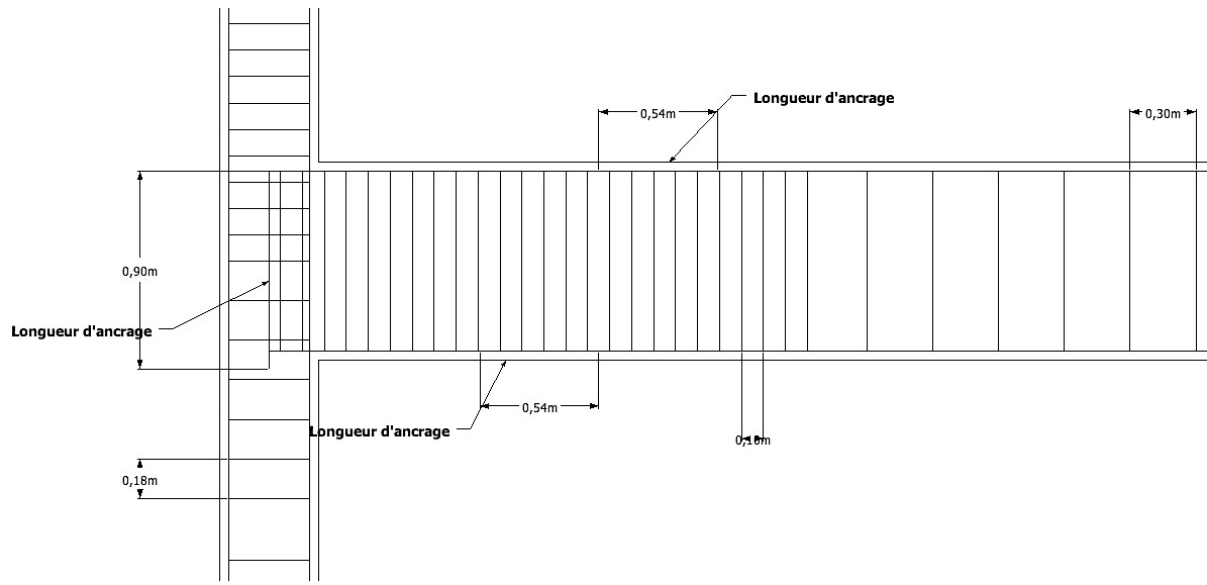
Détail d'armaturage de la liaison poutre-colonne inférieure
